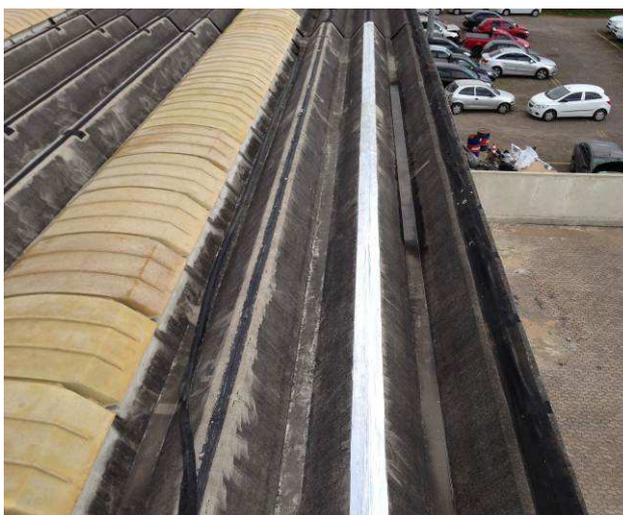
C: Aplicação de manta asfáltica aluminizada nas juntas das telhas do barracão novo.
